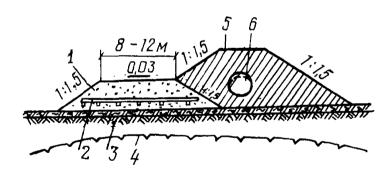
Рис. I.>. Поперечный профиль насыпи со сланевым настилом на участках четвертой группы ландшафтных комплексов при наземной прокладке трубопровода:
